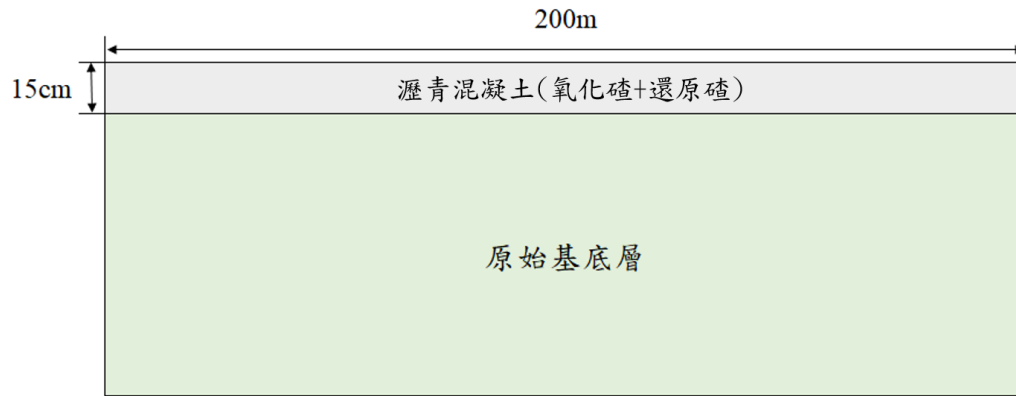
瀝青混凝土(氧化矽+還原矽)試驗道路斷面示意圖
